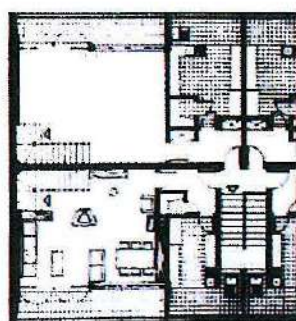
Bairro das Estacas, Planta do piso tipo (duplex), tipo 3. Duplex, 1.^o piso, in Tatiana Branco, op. cit., pág. 65.
